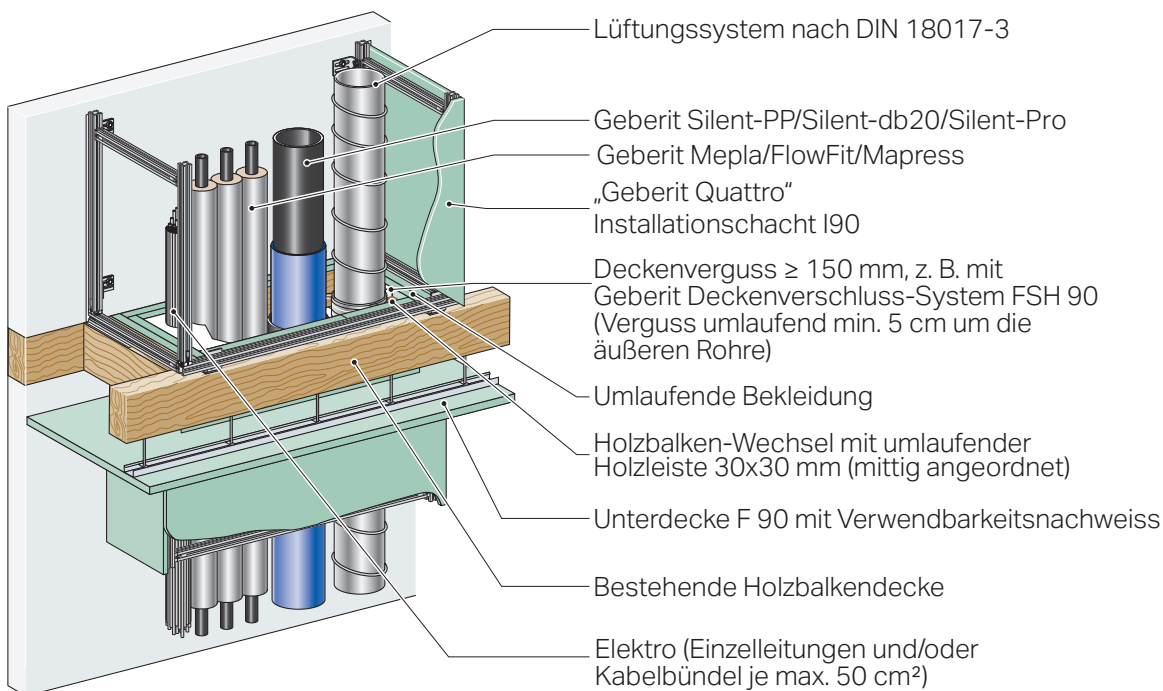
Geberit Quattro Komplettsystem in Verbindung mit Holzbalkendecken mit F 30 / F 90 Unterdecke
